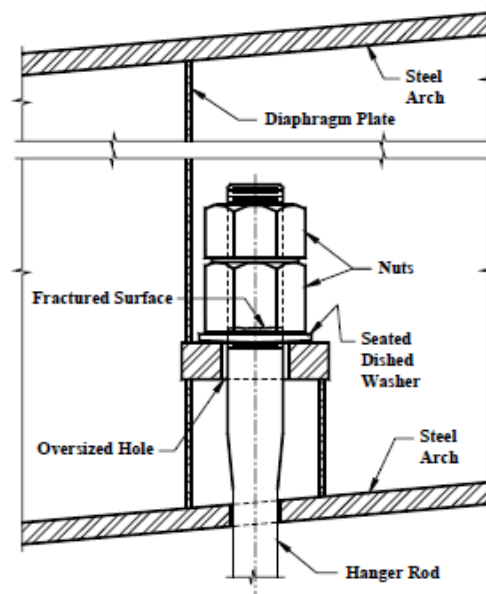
Desenho esquemático da ligação dos pendurais ao arco da ponte. [10]
